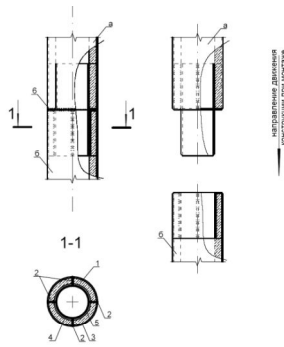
Стык центрифугированных трубобетонных колонн по длине: *a* - вышележащая колонна; *b* - нижерасположенная колонна; 1 - центрифугированный бетон; 2 - ребра жесткости в опорных узлах колонны; 3 - наружная труба-оболочка; 4 - внутренняя труба-оболочка (стакан); 5 - стыковочная труба-вставка; 6 - монтажный сварочный стык
